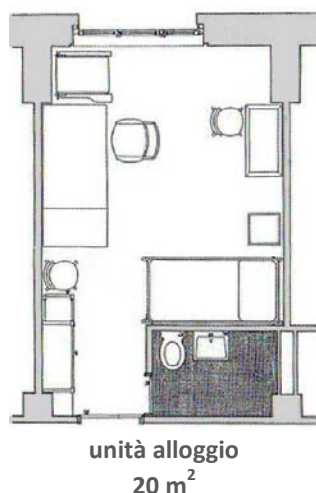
Luigi Moretti, casa-albergo in via Filippo Corridoni, Milano 1948, pianta alloggio tipo.
